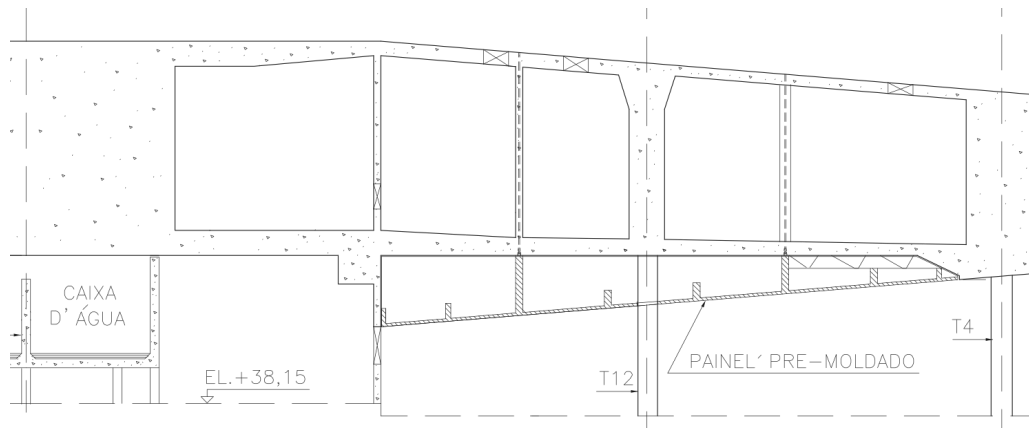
Detalhe em corte de uma pétala das vigas protendidas, bloco A; Fonte: Arquivo da PGR
